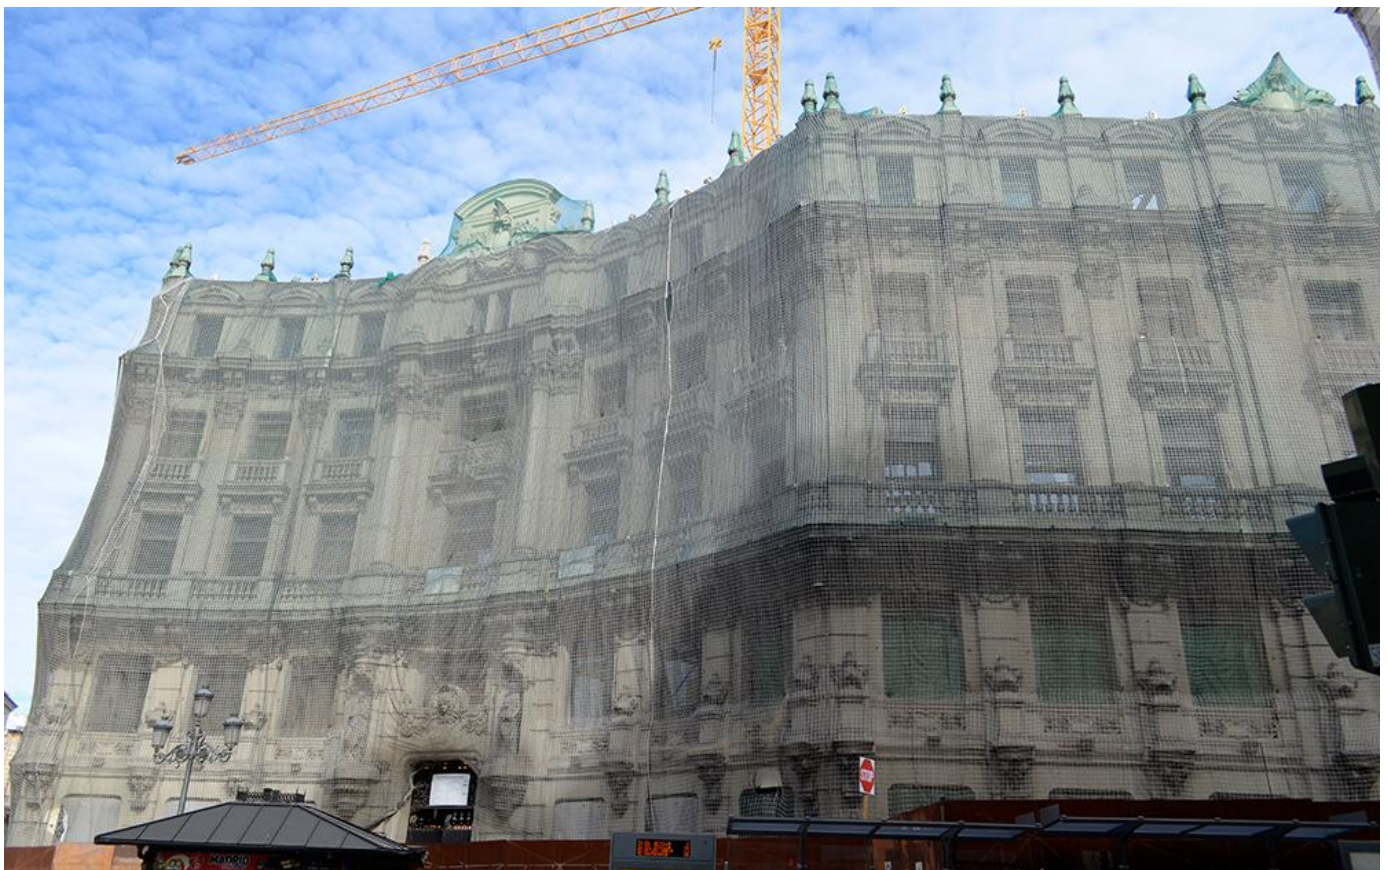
Vista general de la fachada principal del antiguo Banco Hispano Americano.
